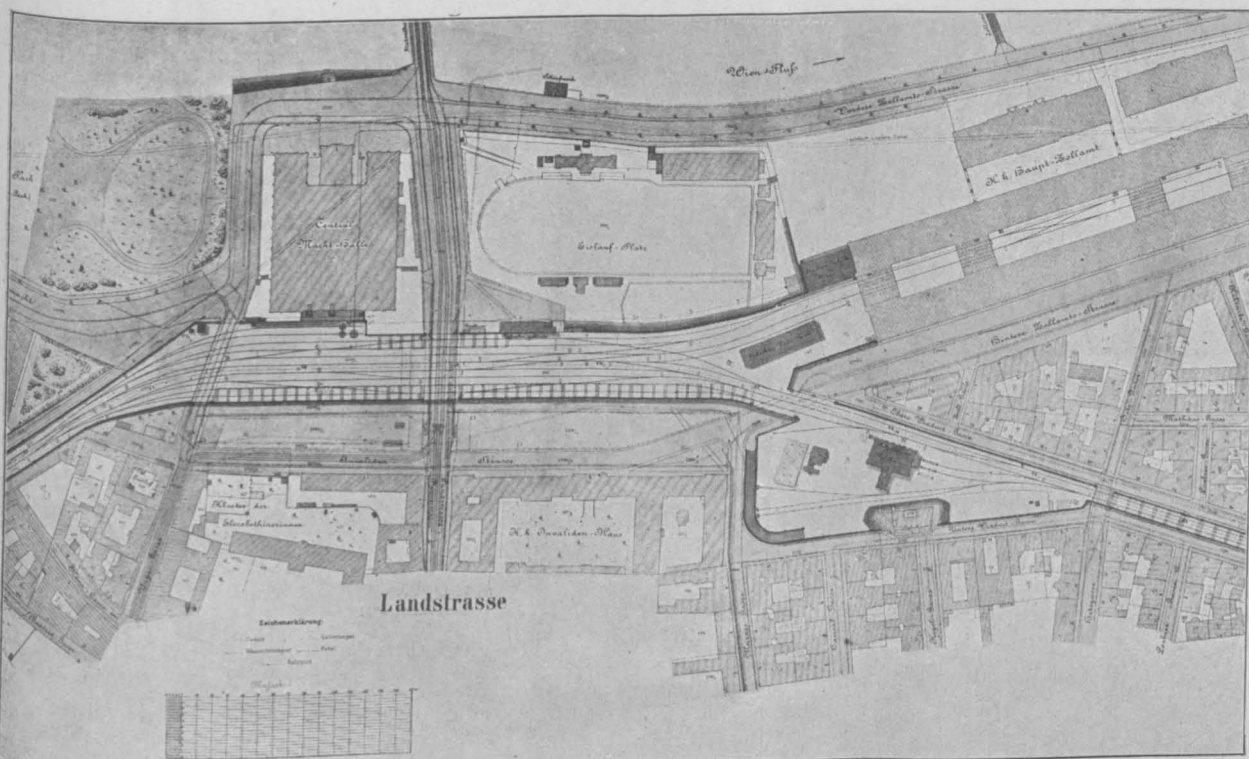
Lageplan des alten Bahnhofes. 1:5000.
